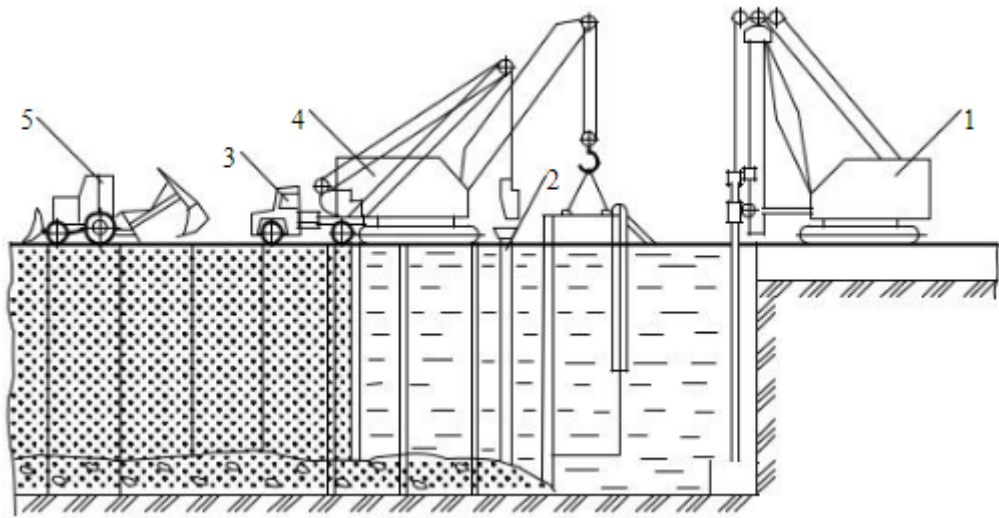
Технологічна схема влаштування «стіни в ґрунті»: 1 – штанговий екскаватор, 2 – бетонолитна труба, 3 – автокран для укладання бетону, 4 – кран для монтажу панелей, 5 – механізм для зворотної засипки
